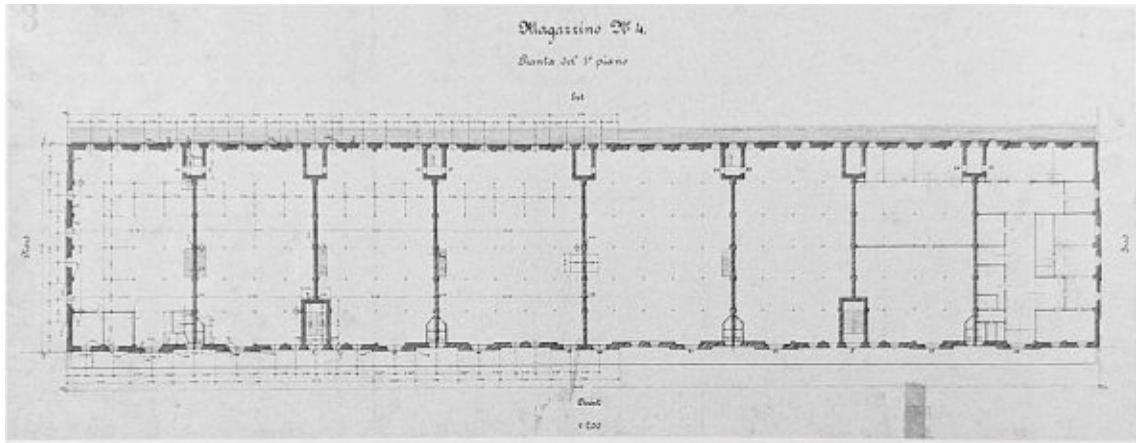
Lagerhaus 4, Grundriss.
